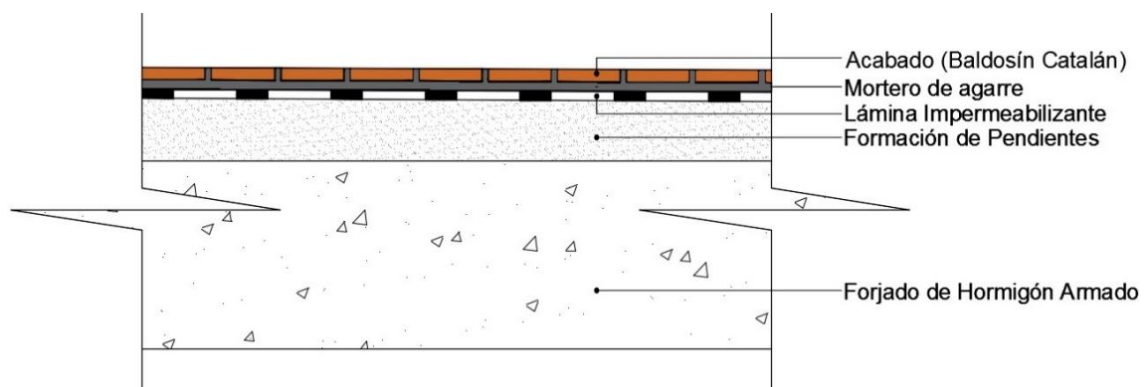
Sección constructiva del cerramiento de la cubierta principal del edificio
